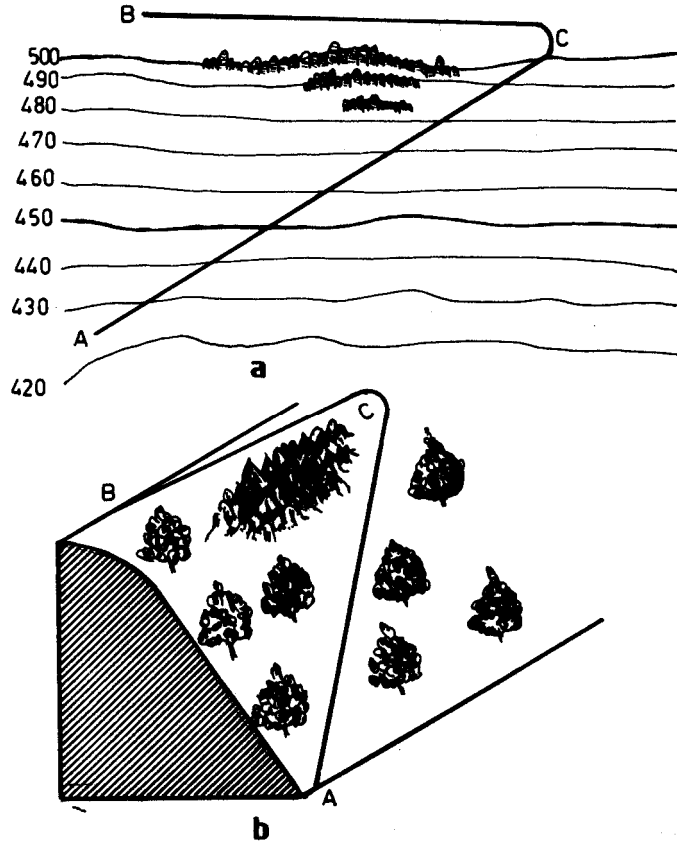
a) Sivri dönüşlerin plan görünüşü
